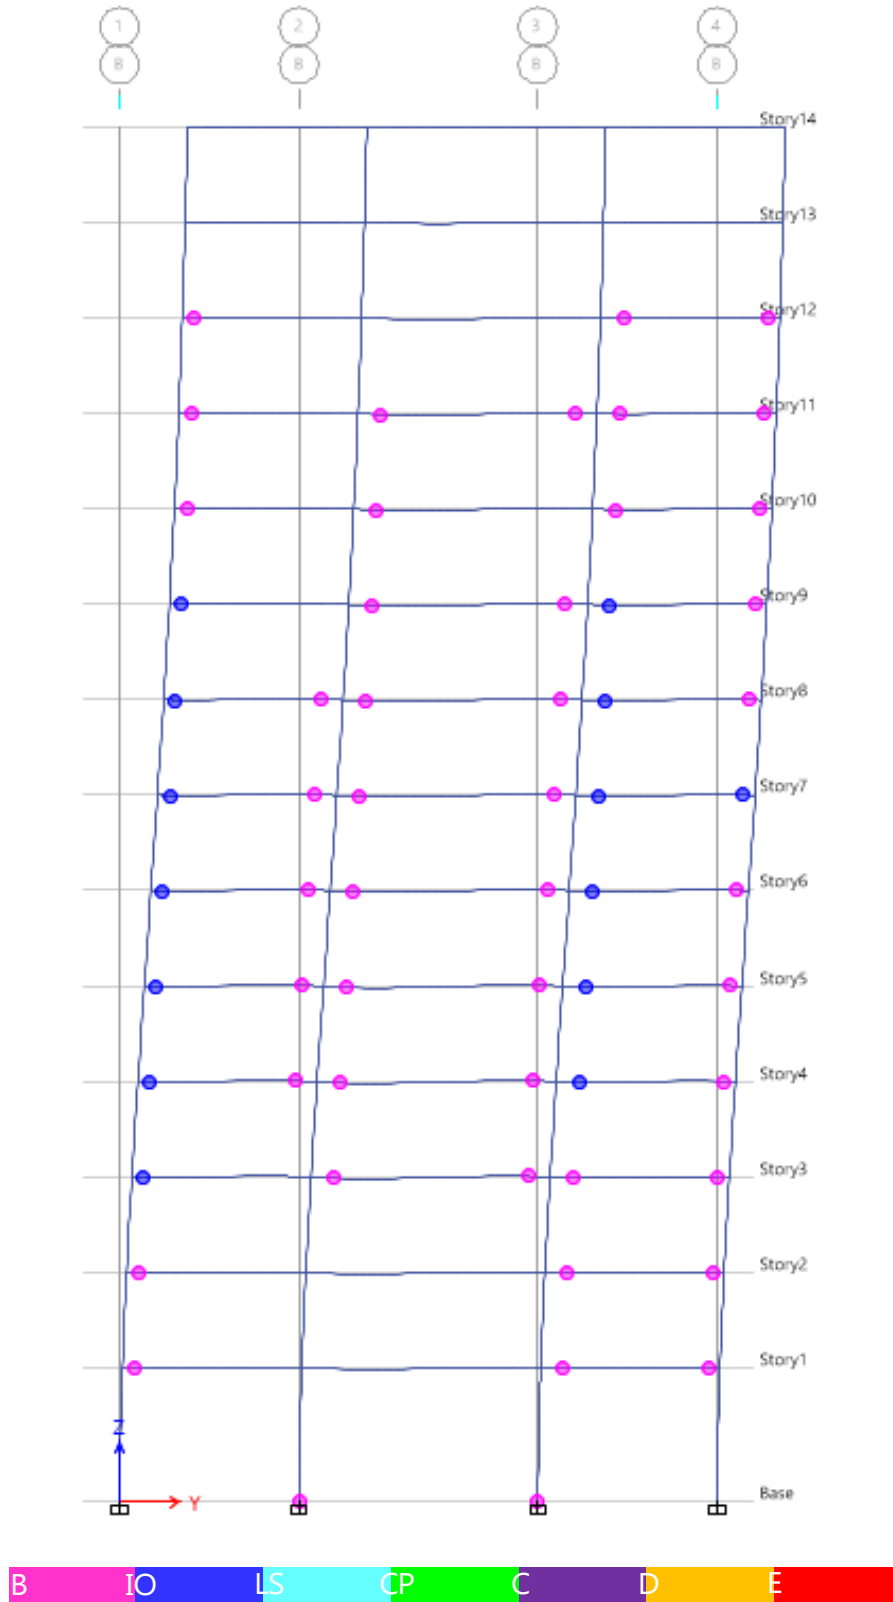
Formulación rótulas plásticas Eje C para BSE-1 en dirección y (Pórtico a momento hormigón armado NEC-11).
